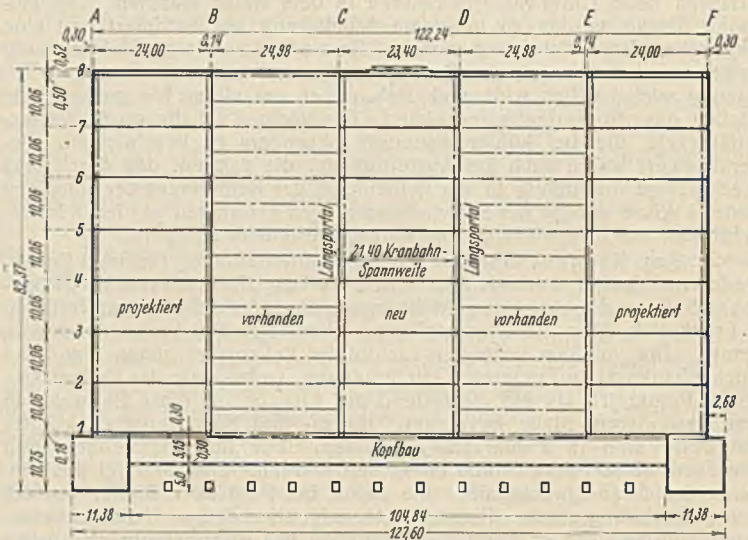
Grundriß der Mittelhallen und des Kopfbaues mit den projektierten Seitenhallen, die den sinngemäß gleichen Querschnitt wie die Mittelhallen erhalten haben.
